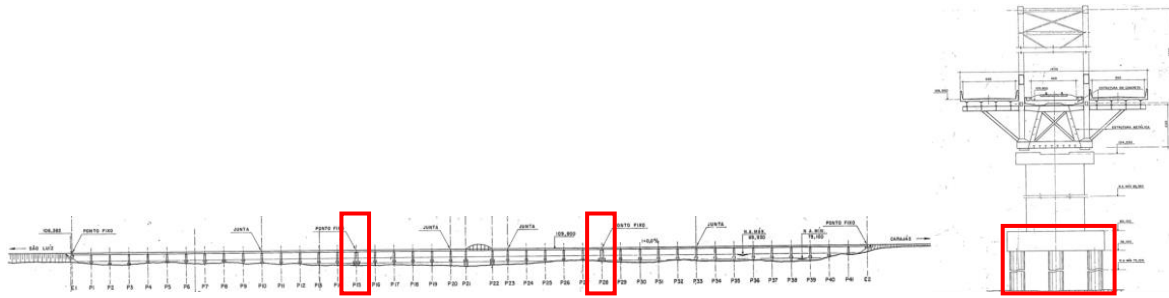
Elevação e corte da ponte indicando os pontos de reforço da infraestrutura no P15 e P28.
